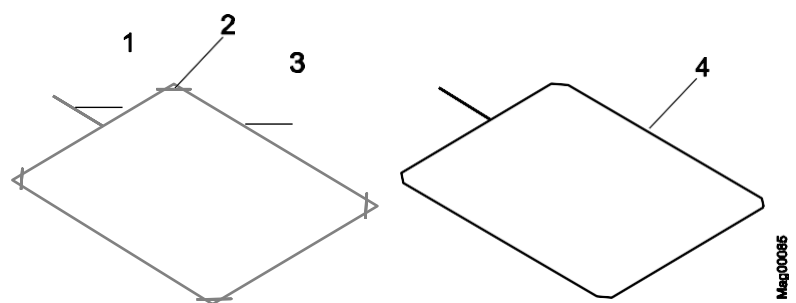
Coloque el lazo inductivo sobre betún, asfalto u hormigón.
